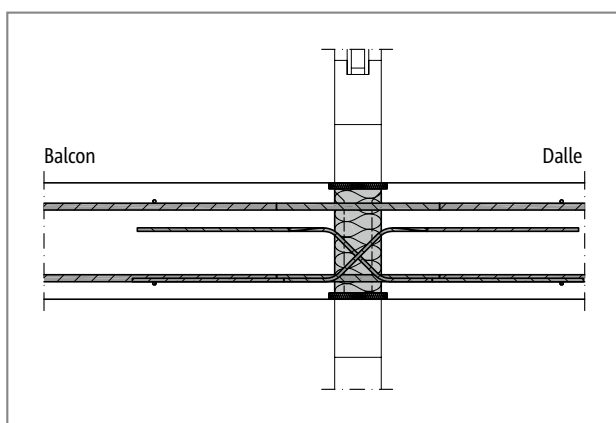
Schöck Isokorb® T Type D : Coupe de montage ; plancher à axe unique
